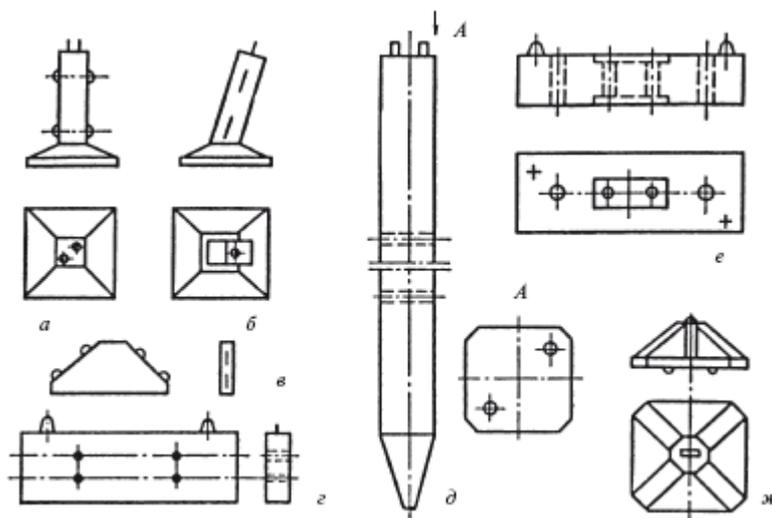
Детали сборных железобетонных фундаментов опор ВЛ: *а* – прямой подножник; *б* – наклонный подножник; *в* – пригрузочная плита; *г* – ригель; *д* – свая; *е* – ростверк; *ж* – анкерная плита для крепления оттяжек
